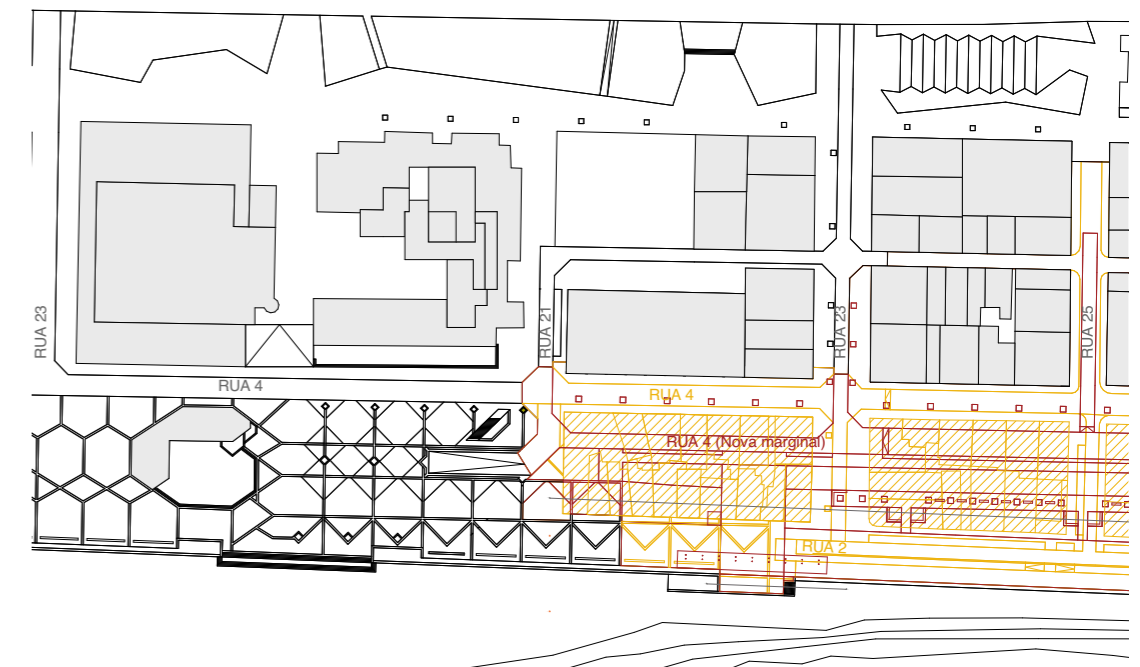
Planta da intervenção a norte. Esc: 1\_500.
